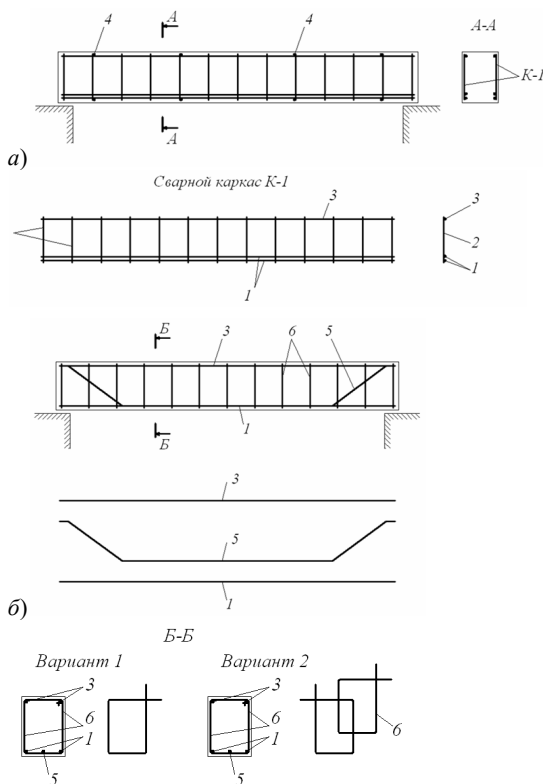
Схемы армирования балок: *a* – однопролетная балка со сварными каркасами; *б* – то же, с вязаной арматурой; 1 – продольные рабочие стержни; 2 – поперечные стержни каркасов; 3 – продольные монтажные стержни; 4 – поперечные соединительные стержни; 5 – рабочие стержни с отгибами; 6 – хомуты вязаных каркасов
